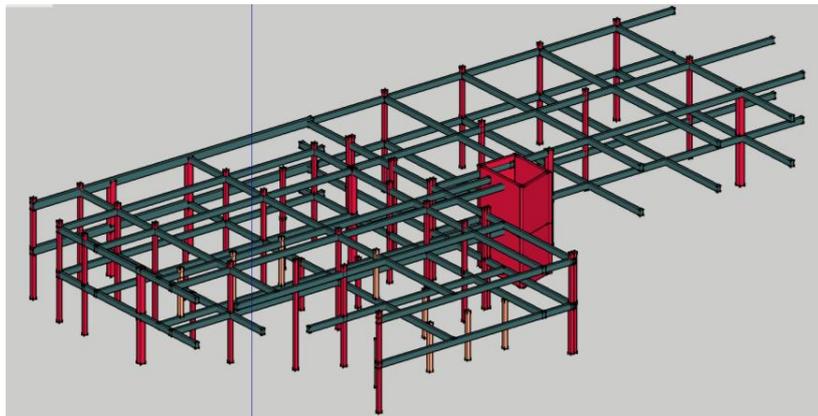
Gambar Ilustrasi massa bangunan Galeri Seni Mural di Kota Balikpapan
